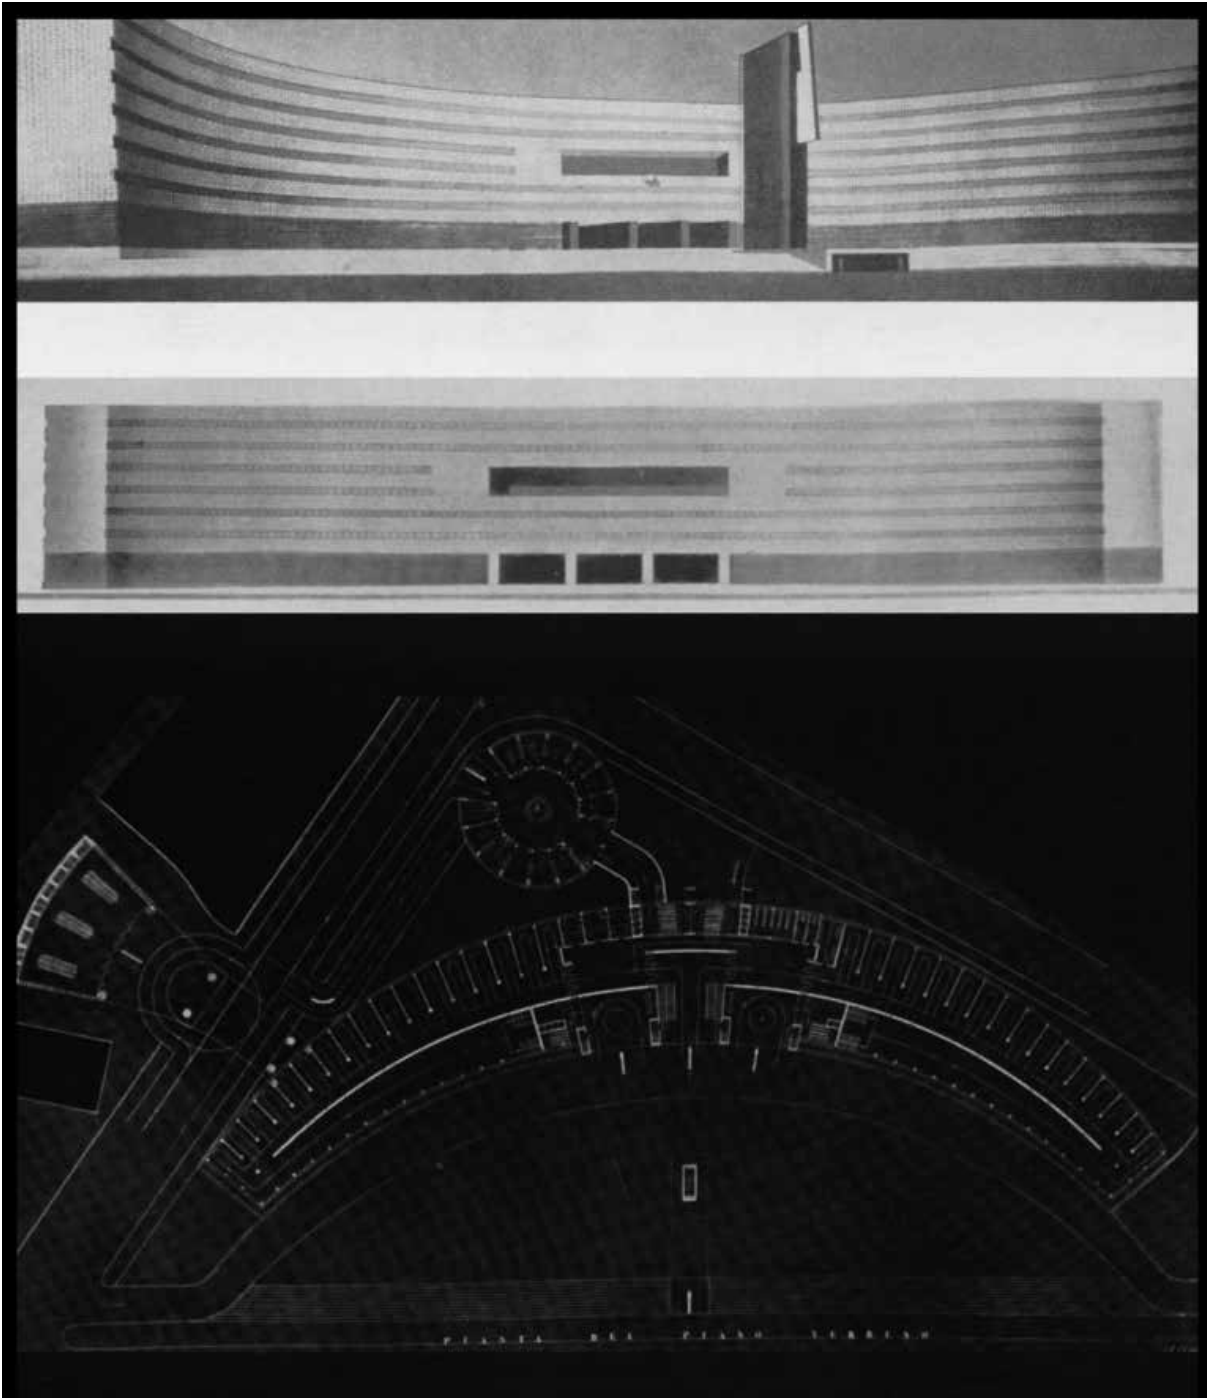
Progetto per il Palazzo Littorio di Adalberto Libera, vista prospettica, prospetto, pianta del piano terreno.
